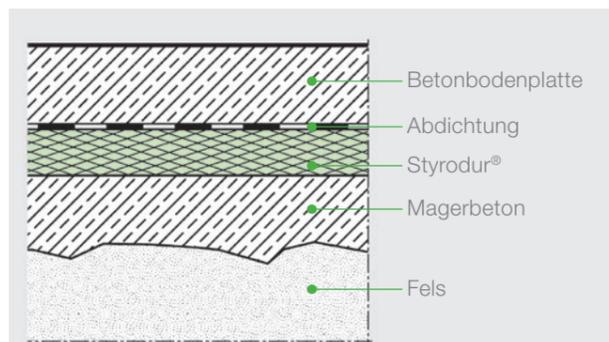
Ausgleichsschicht aus Magerbeton bei Baugrund Fels.
